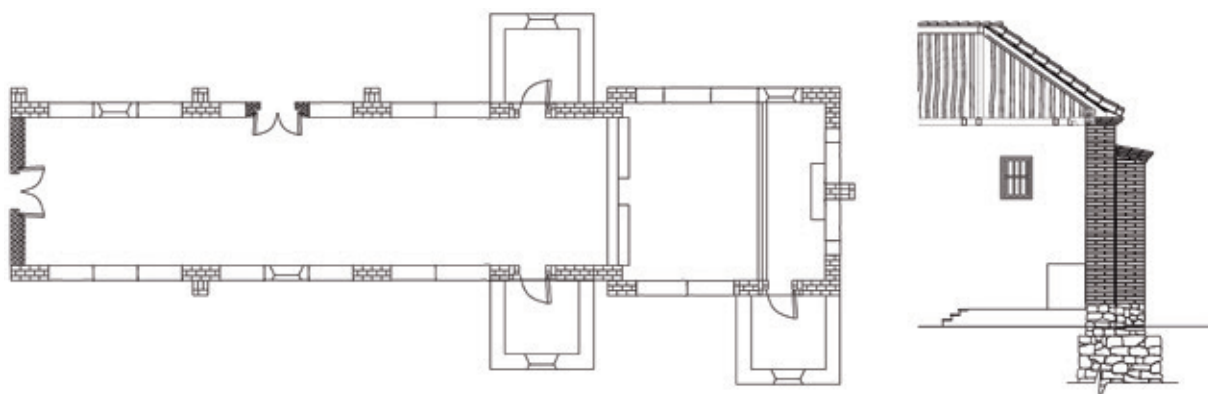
Planos de la iglesia de Sora-Furaquirá-Motavita construida con tapia con rafas y contrafuertes de adobe. Planta general y corte del muro testero²⁶.
